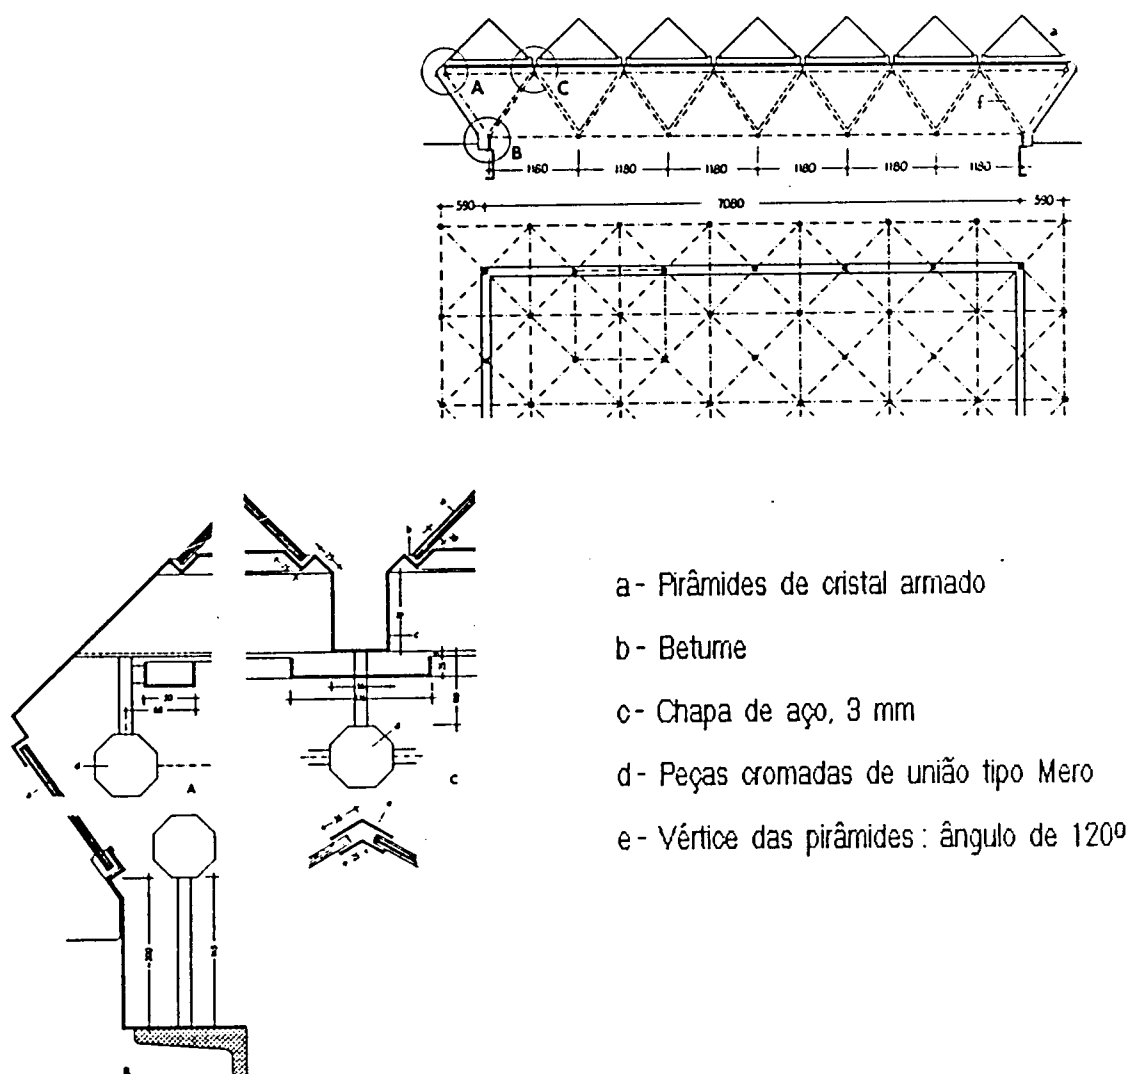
Desenho de parte da planta e da secção vertical da cobertura do Pavilhão de Salzgitte, bem como pormenores da mesma
